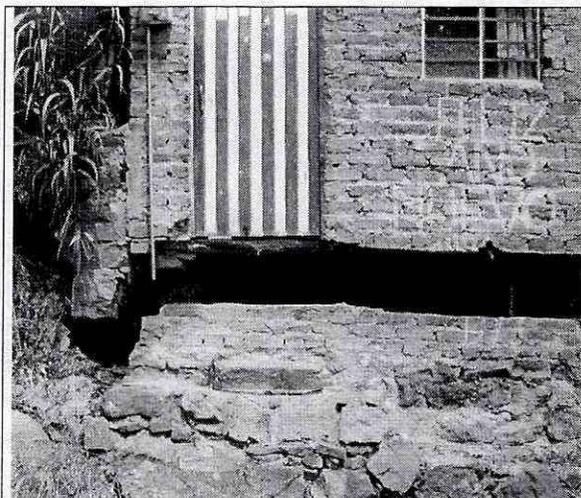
Detalle de la afectación estructural por pérdida del suelo de fundación.
